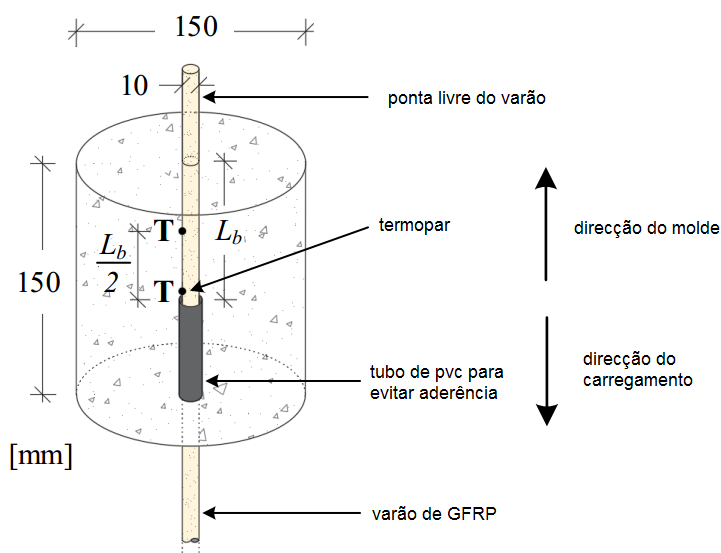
Dimensões e pormenor da colocação dos termopares nos provetes de betão cilíndricos (adaptado de [54])
